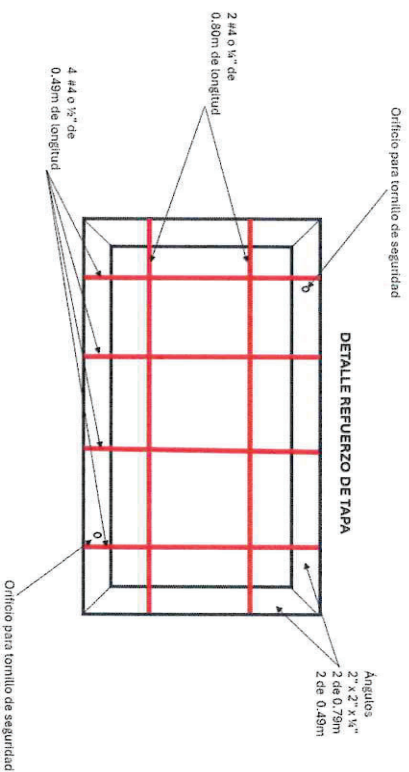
Dimensiones de reforzamiento de concreto y acero de las cámaras de registro.
